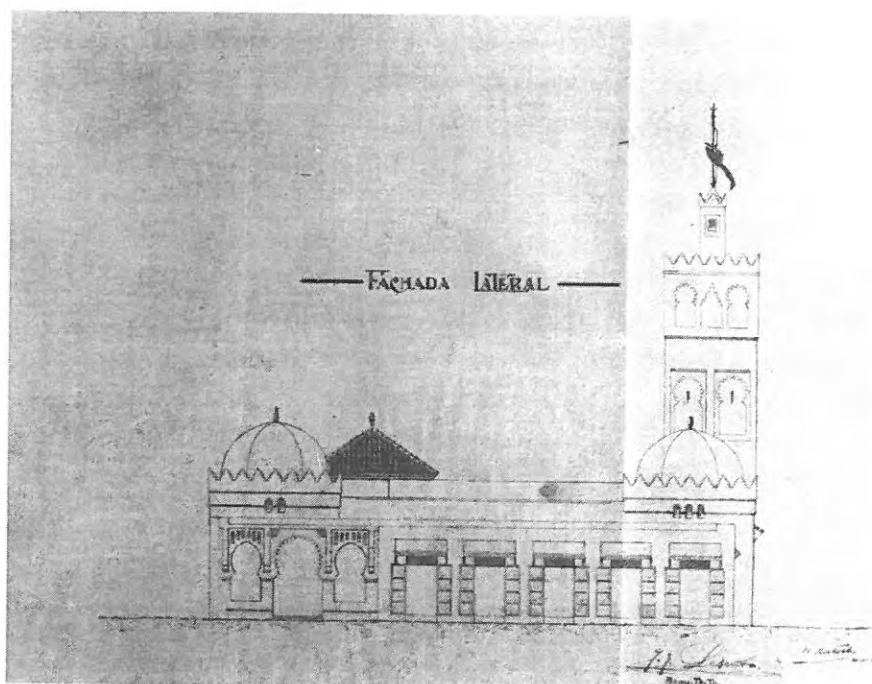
Primer proyecto del Pabellón oficial. Fachada lateral.
